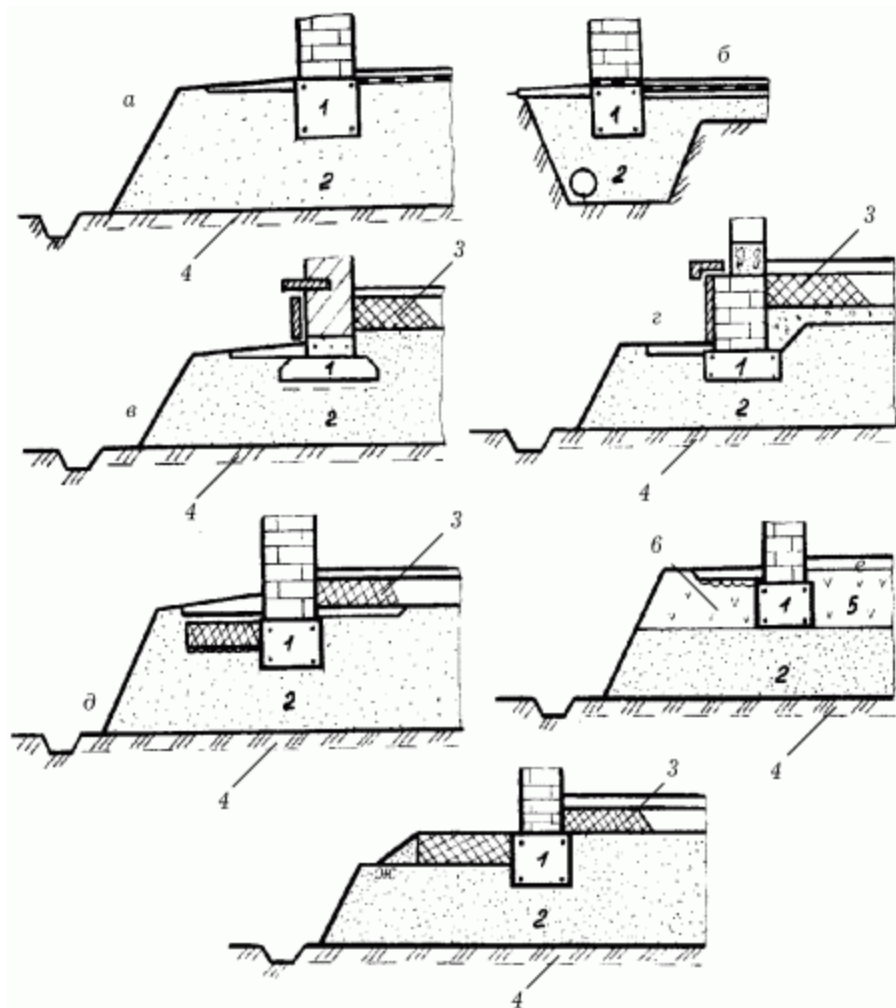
Устройство малозаглубленного фундамента: а – на подсыпке; б – на подсыпке в траншее; в – жилых строений; г – деревянных домов; д, е, ж – на подсыпке с утеплением; 1 – фундамент; 2 – подсыпка из непучинистого материала; 3 – утепление; 4 – водоотводные канавки поперек подсыпки через каждые 2–3 м; 5 – уплотненный торф; 6 – теплоизоляция.
